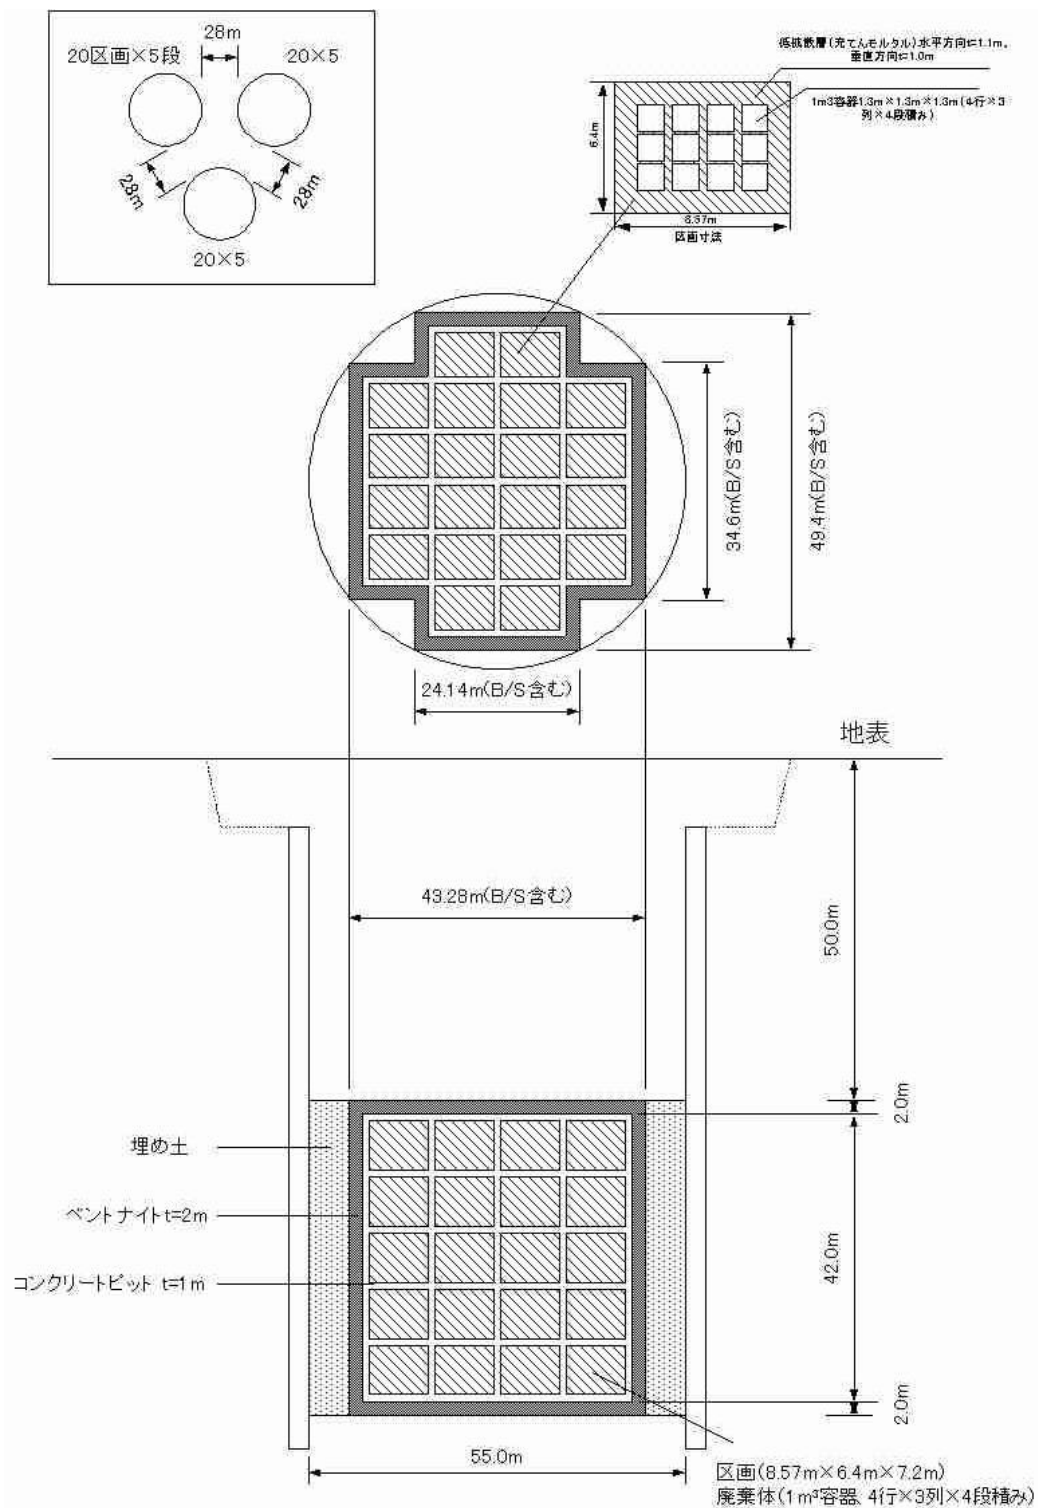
ケース3(新設)の開削サイロ型施設配置図
